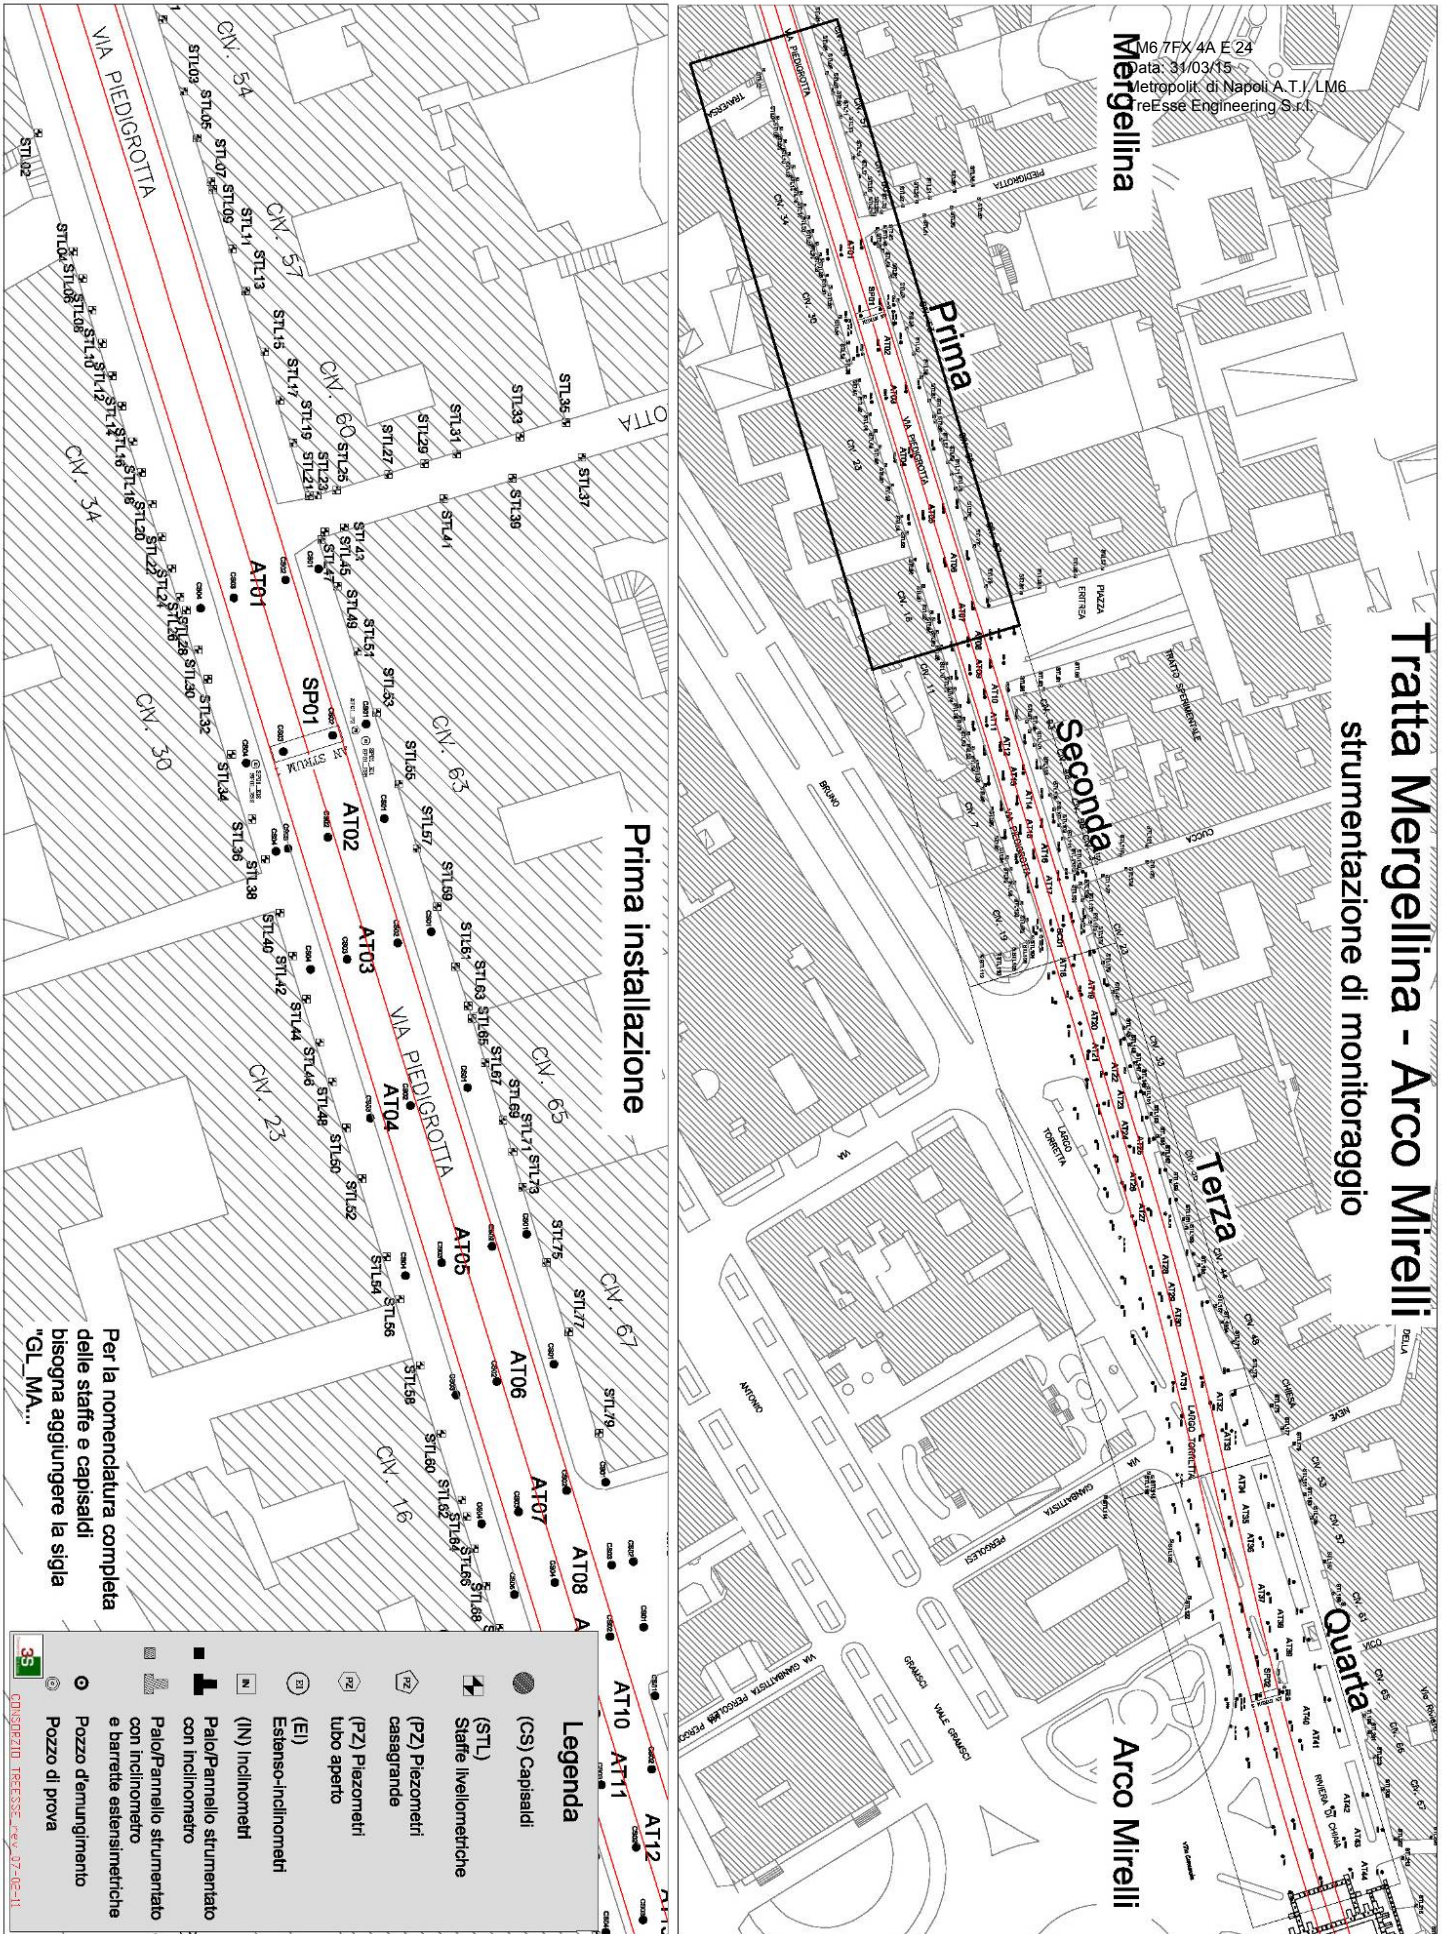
Planimetria tratta Mergellina - Arco Mirelli, raffigurante la disposizione della prima installazione della strumentazione di monitoraggio.
